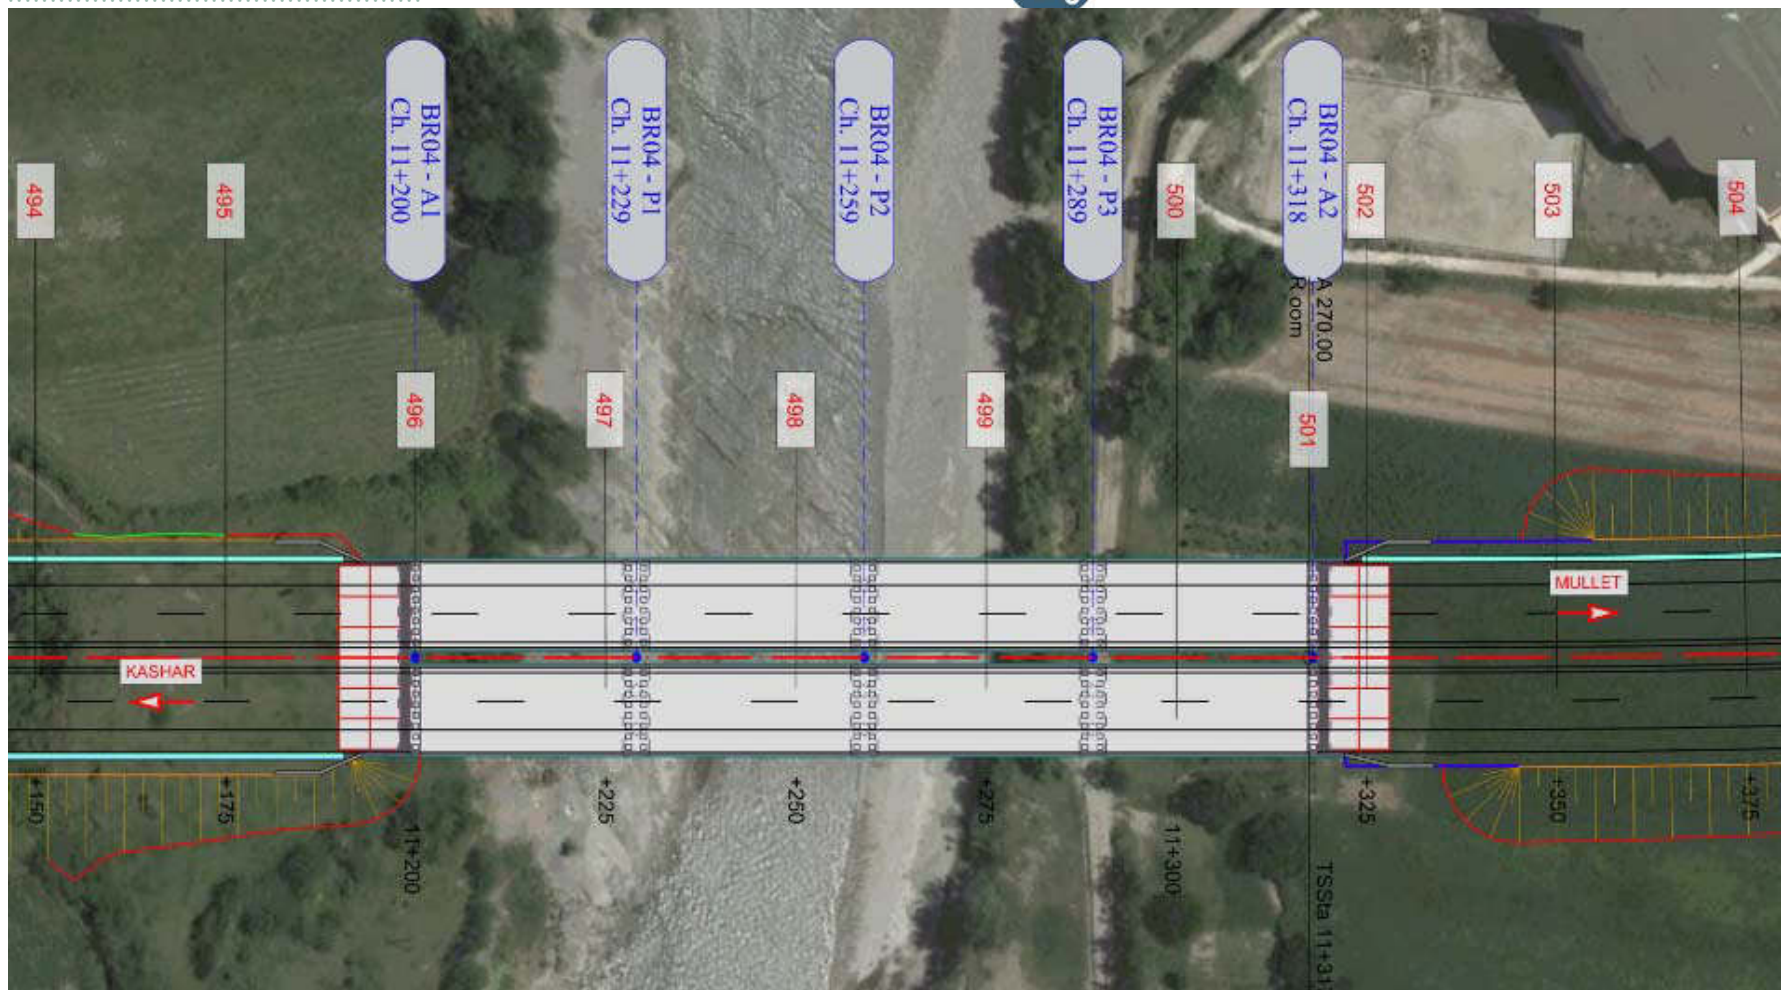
Pamje planimetrike e Urës 04, L=120m (Hapësira 4x30m)
